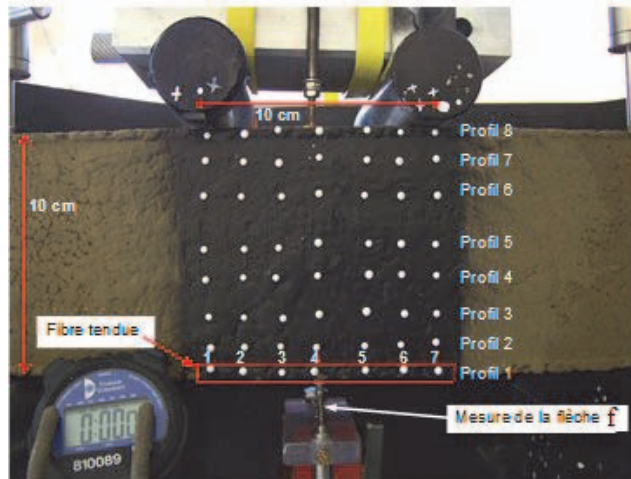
Zone centrale de la poutre en flexion avec le maillage pour suivi photographique (Camp,2008)
